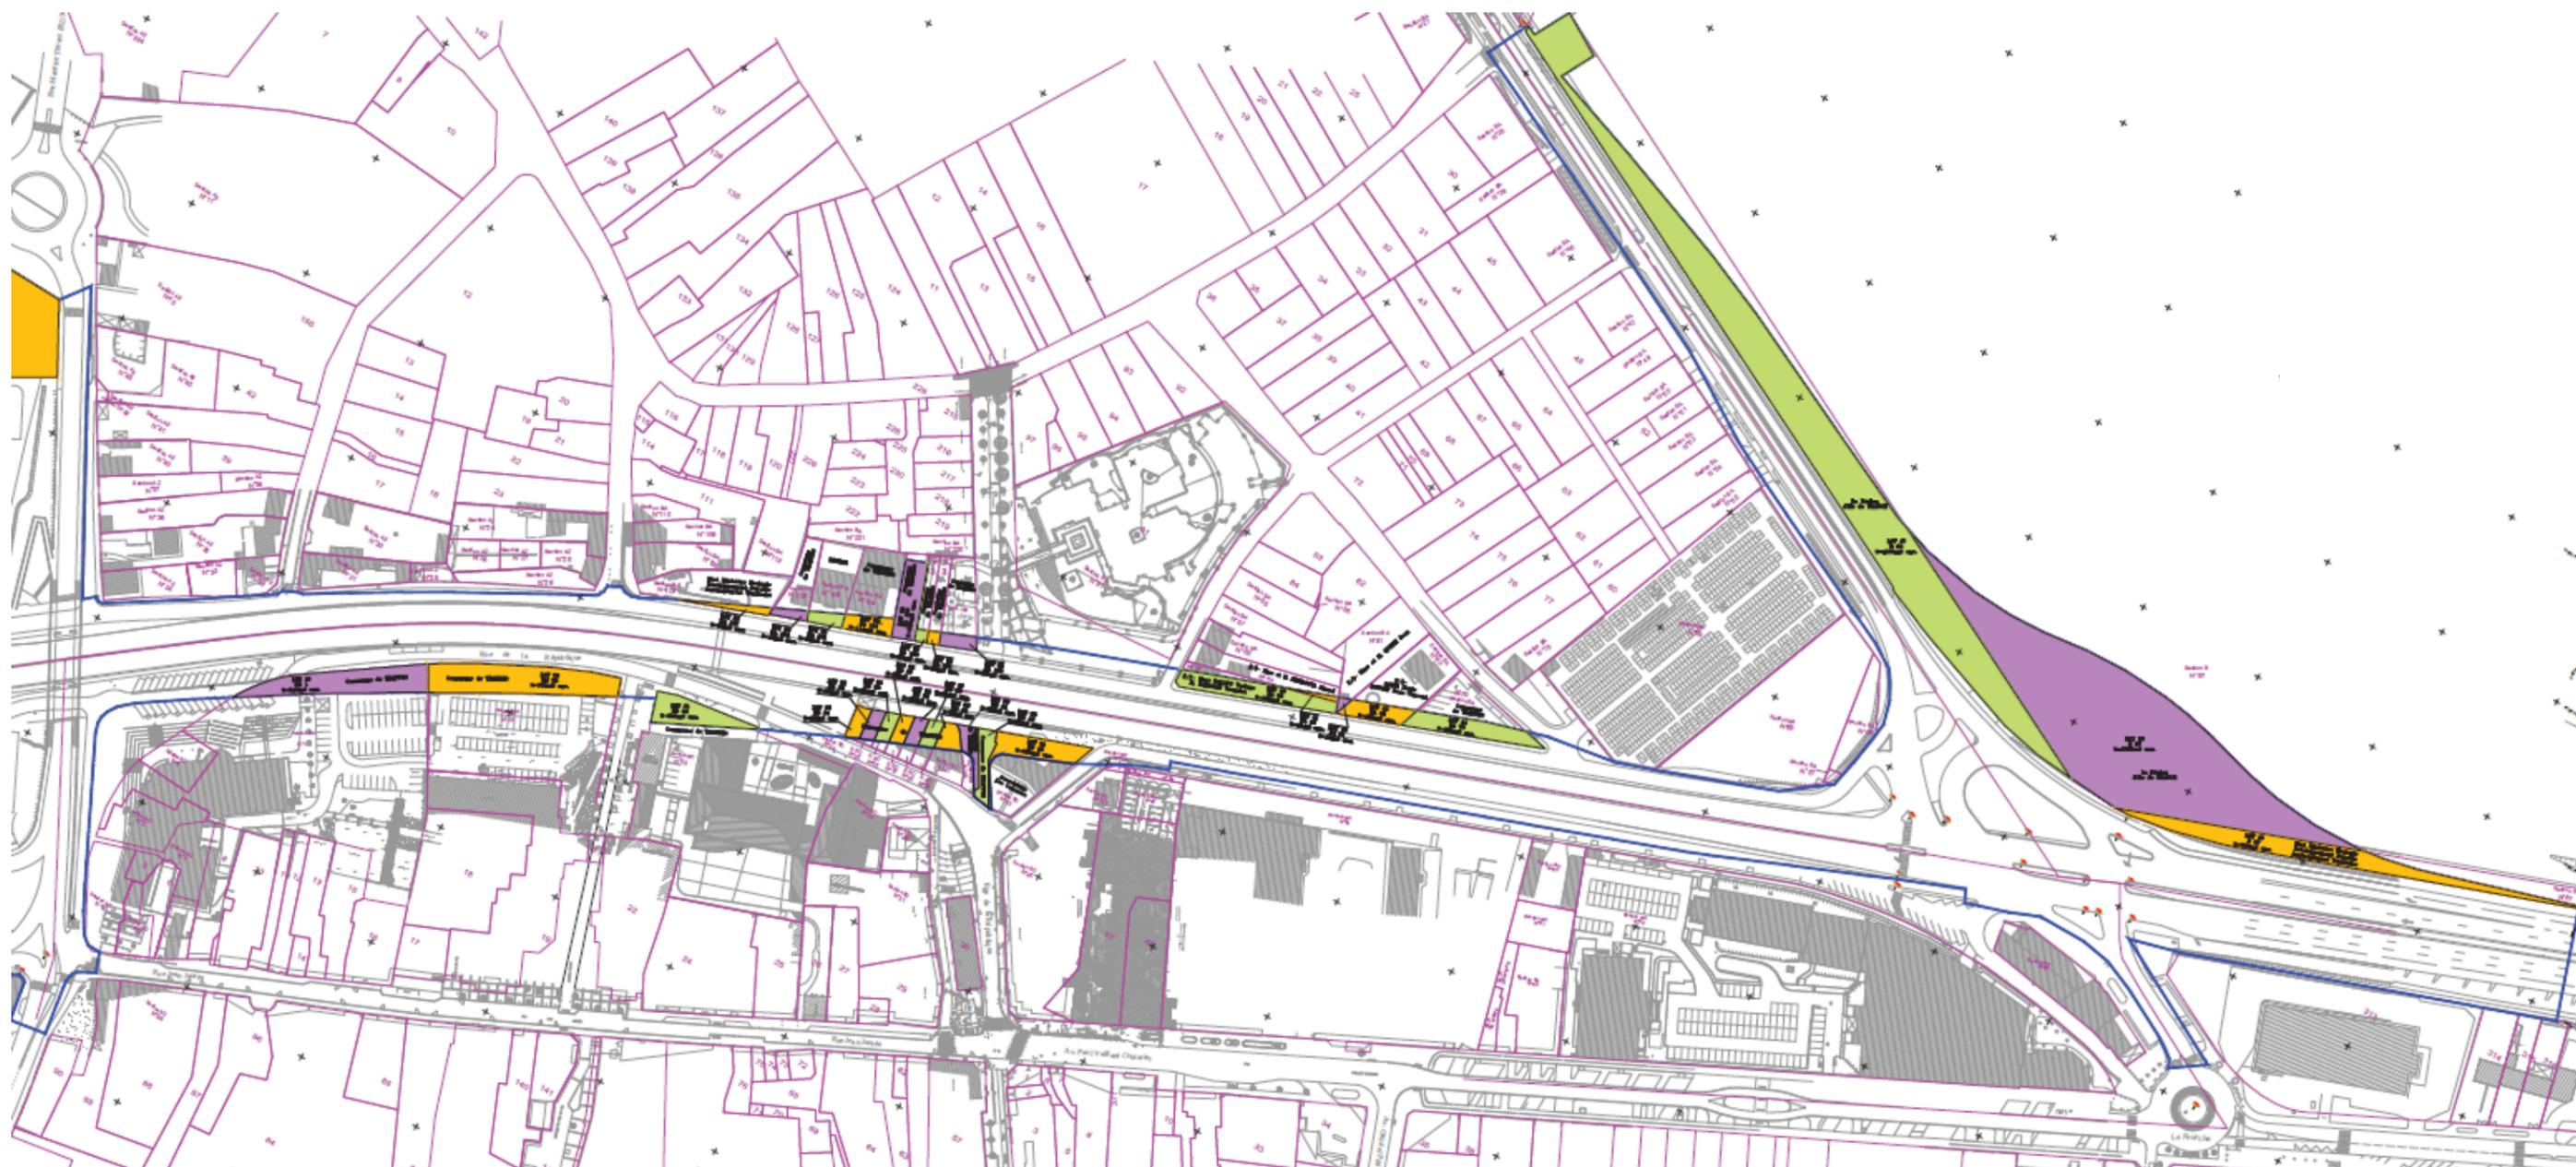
Impact foncier sur la section Est du projet (source : Plans parcellaires géomètre, juin 2015)
